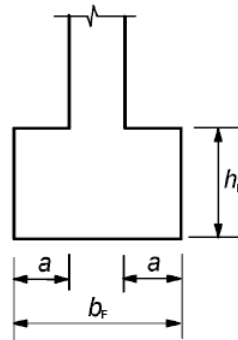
Zapatas aisladas sin armadura; notación
